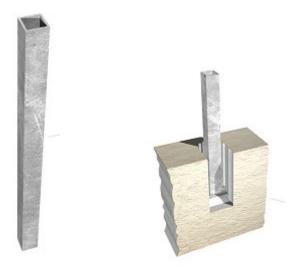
Postes de perfil hueco del cerramiento perimetral
